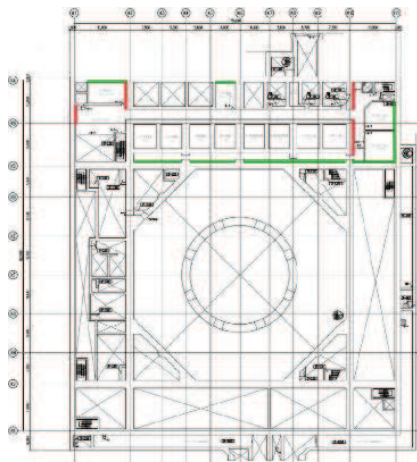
(1) ひび割れ多寡状況図 (女川原子力発電所第 2 号機原子炉建屋)
